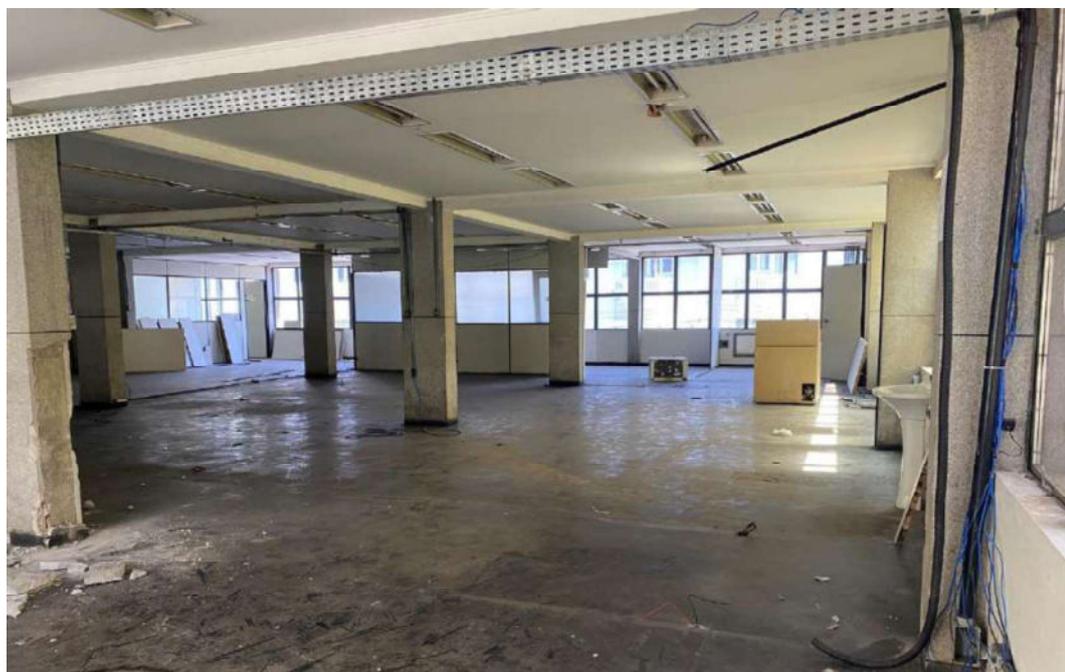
Visão geral - Corrosão de armaduras nos pilares da fachada no pavimento térreo:
